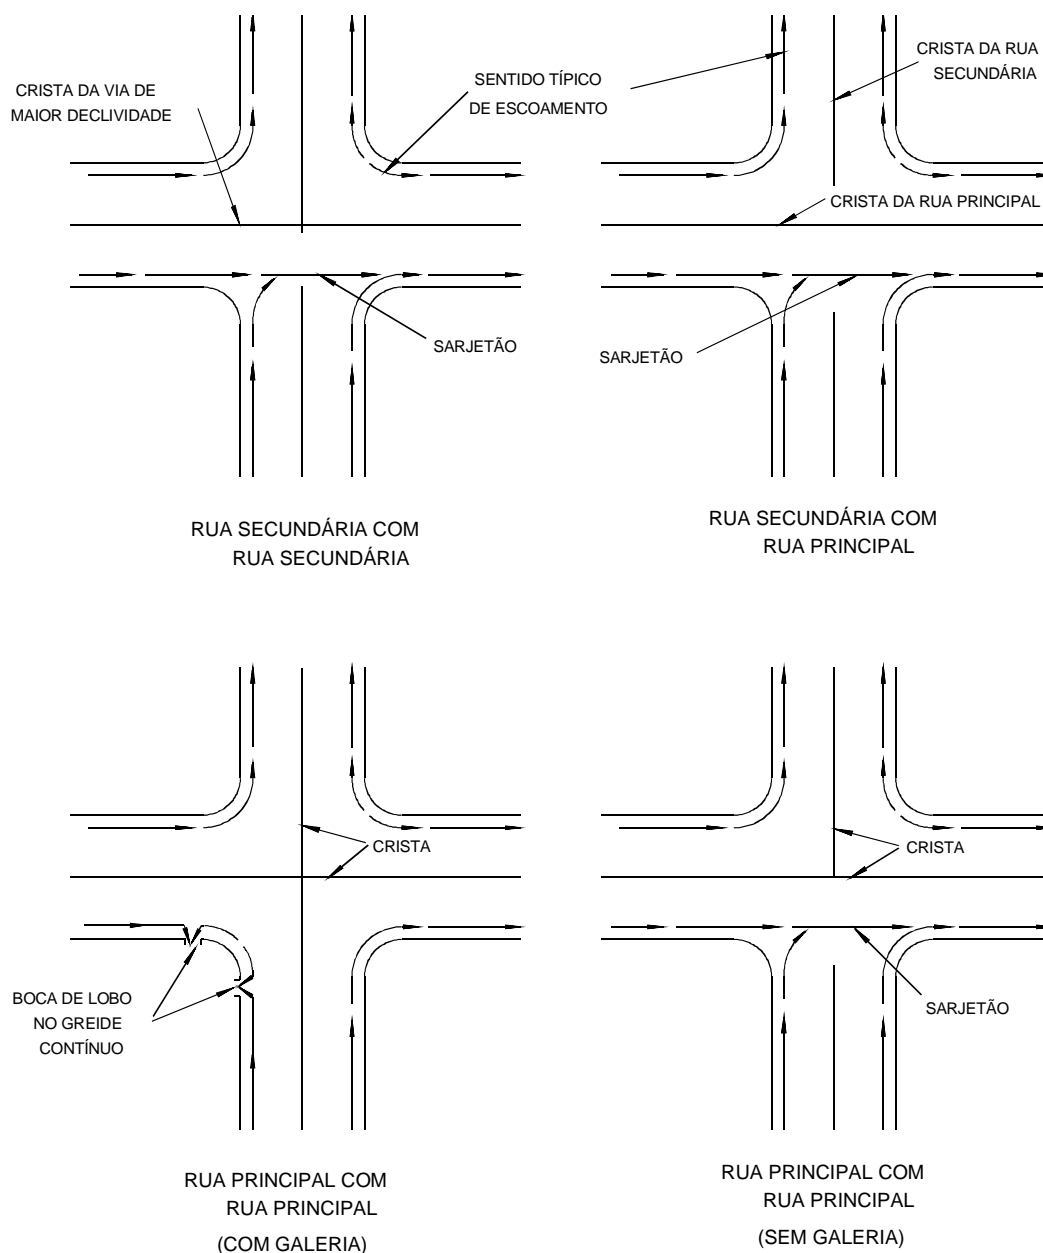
Configurações típicas de cruzamentos em sistema de drenagem.
